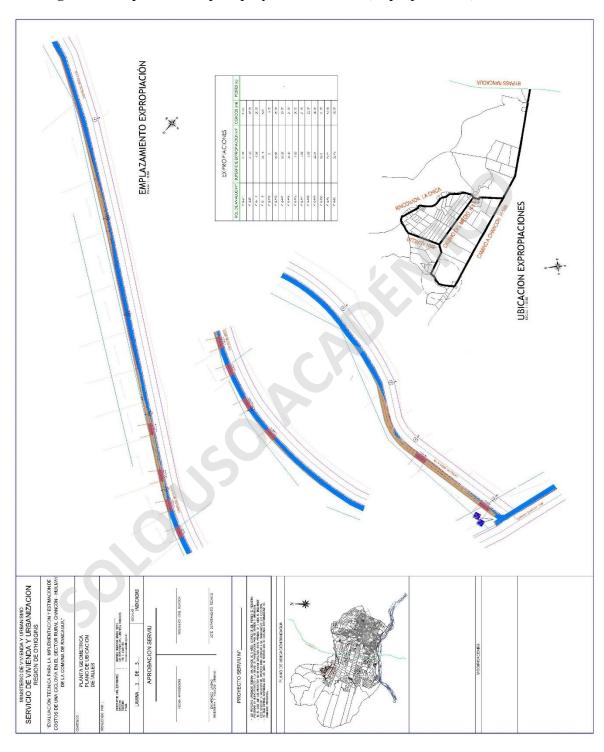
planimetría para proyecto SERVIU. (Ubicación detalles)
